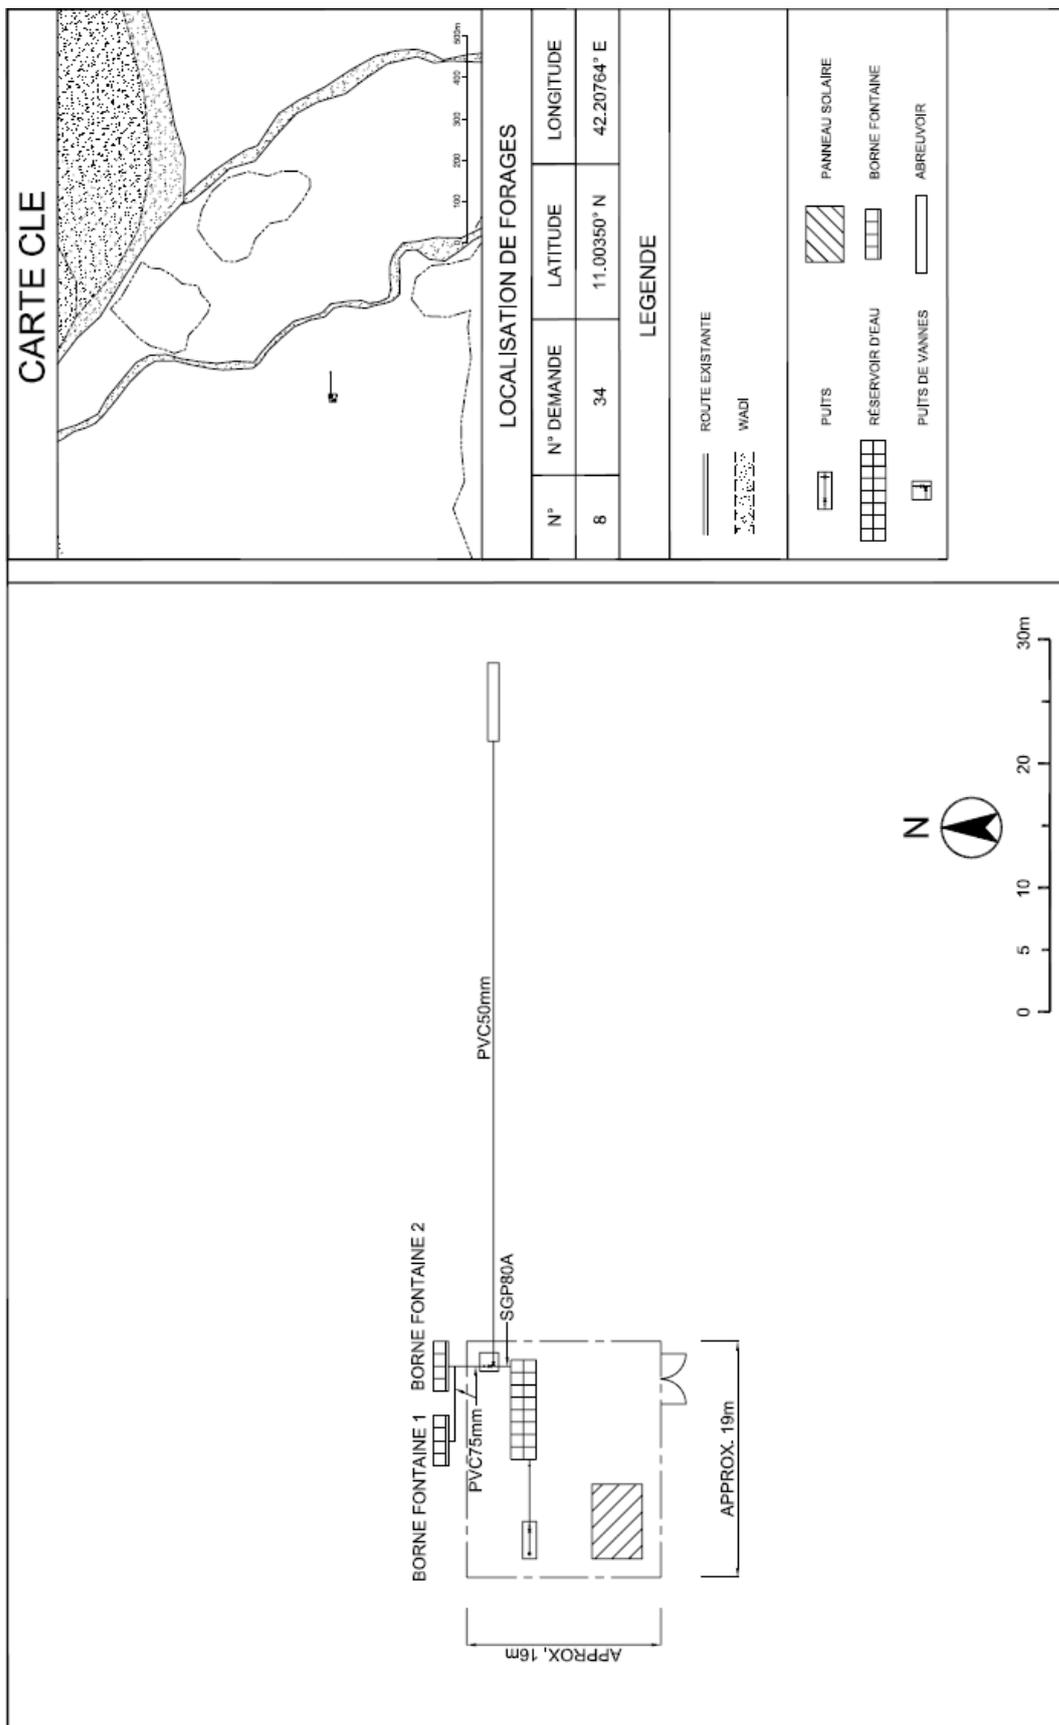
Plan d'implantation des installations (i) [Sankal(Sabbalou)]
